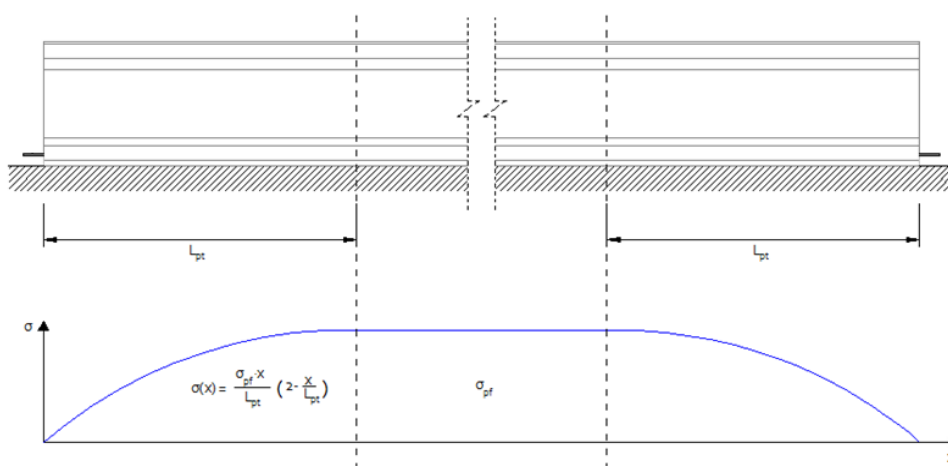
Tensión en las armaduras en la longitud de transferencia.
